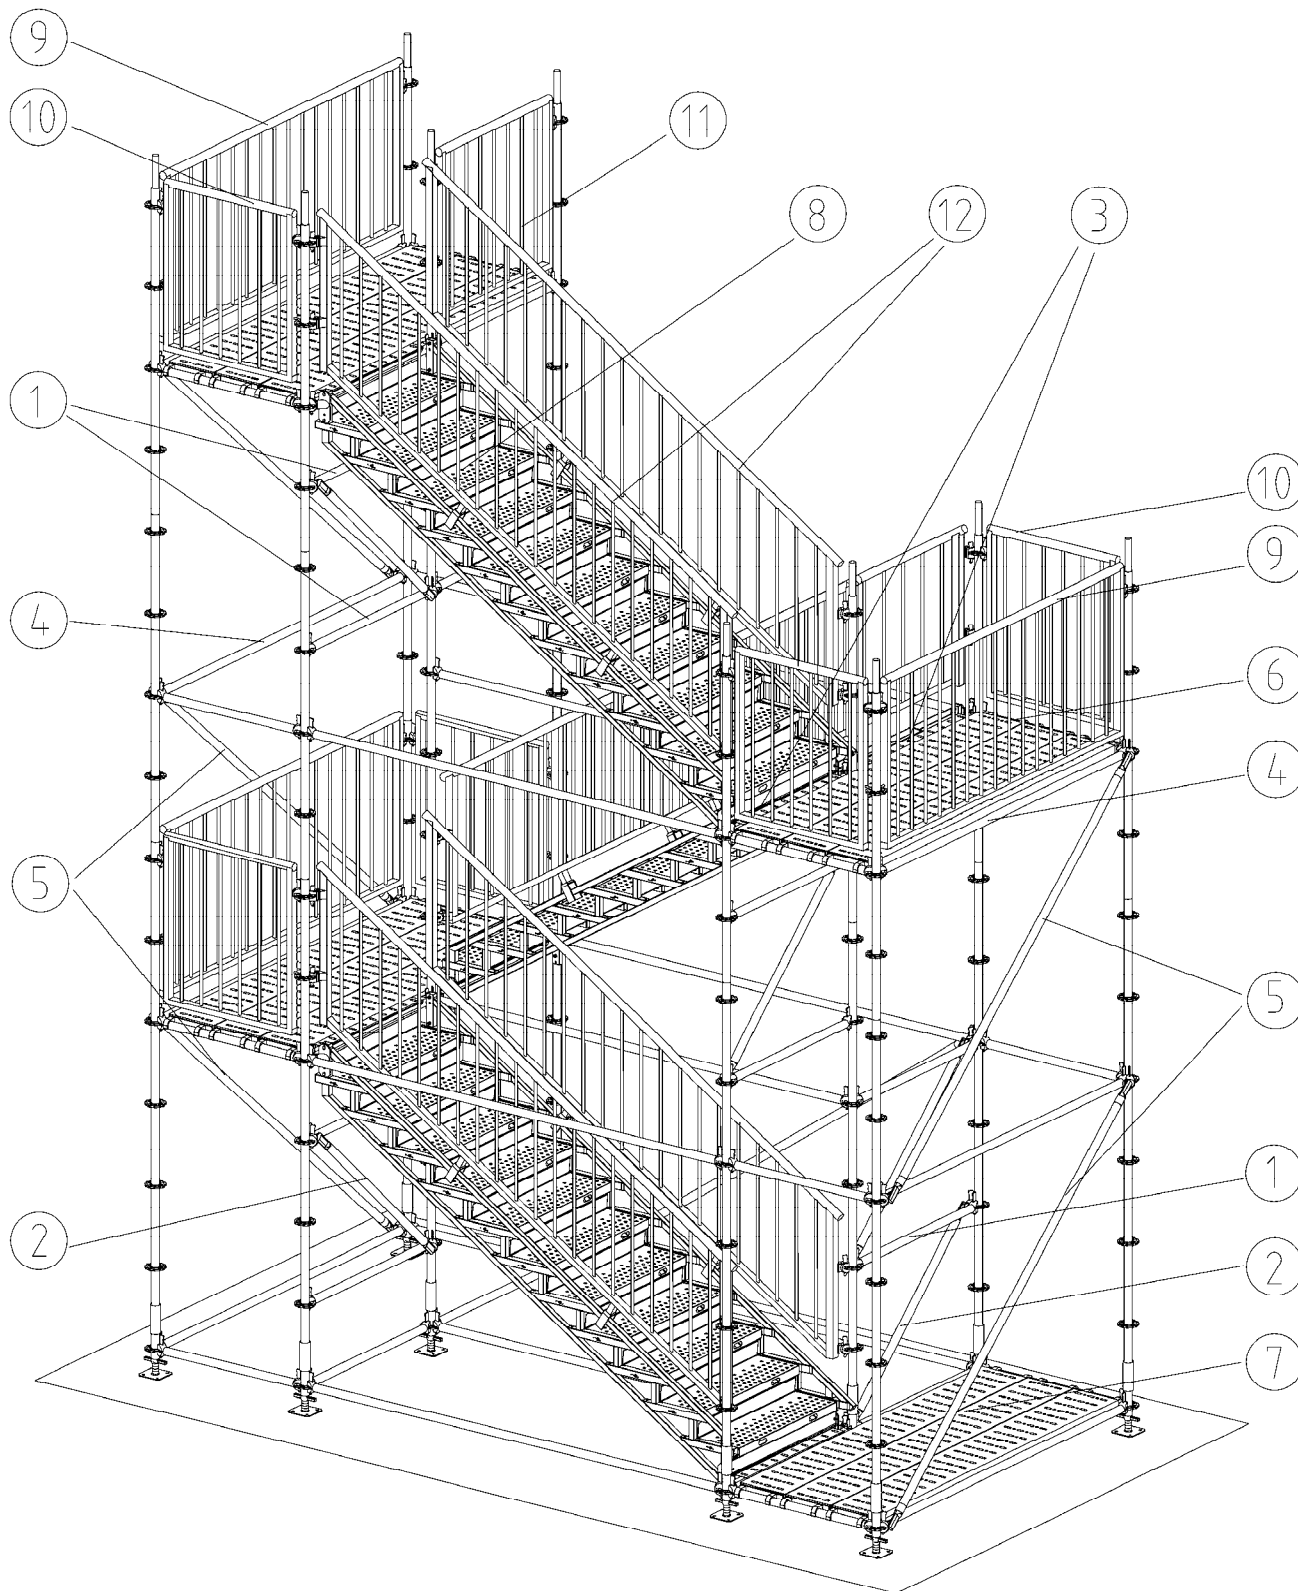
11-Stufen Treppenturm der Laufbreite 1,0 m mit einer Standhöhe von 6,0 m und mit Belägen für Rundrohrauflage
